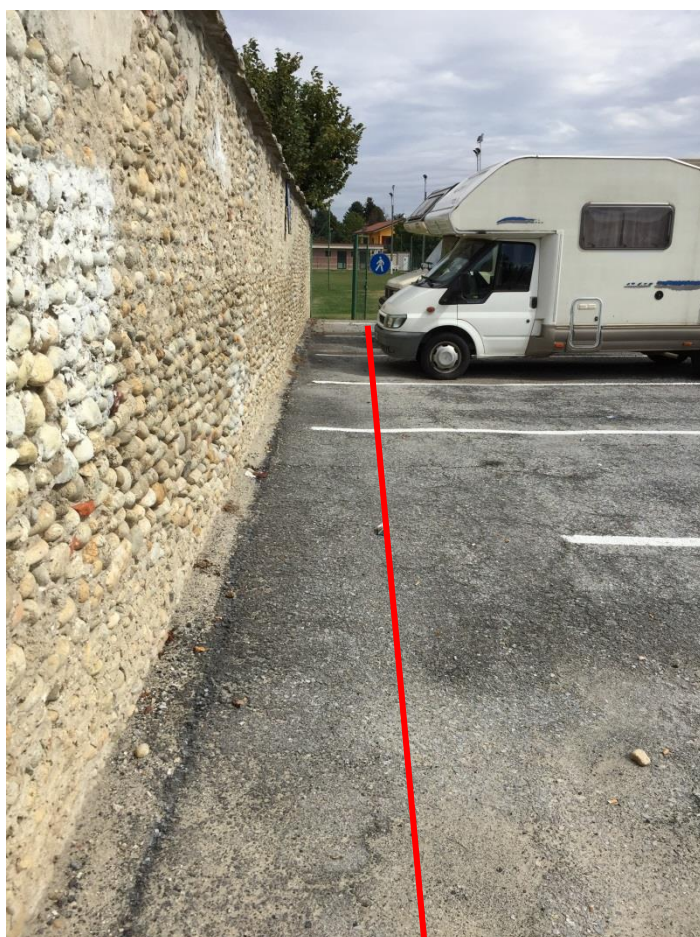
VIA TORRE, TRATTO NUOVO ATTRAVERSAMENTO PEDONALE
